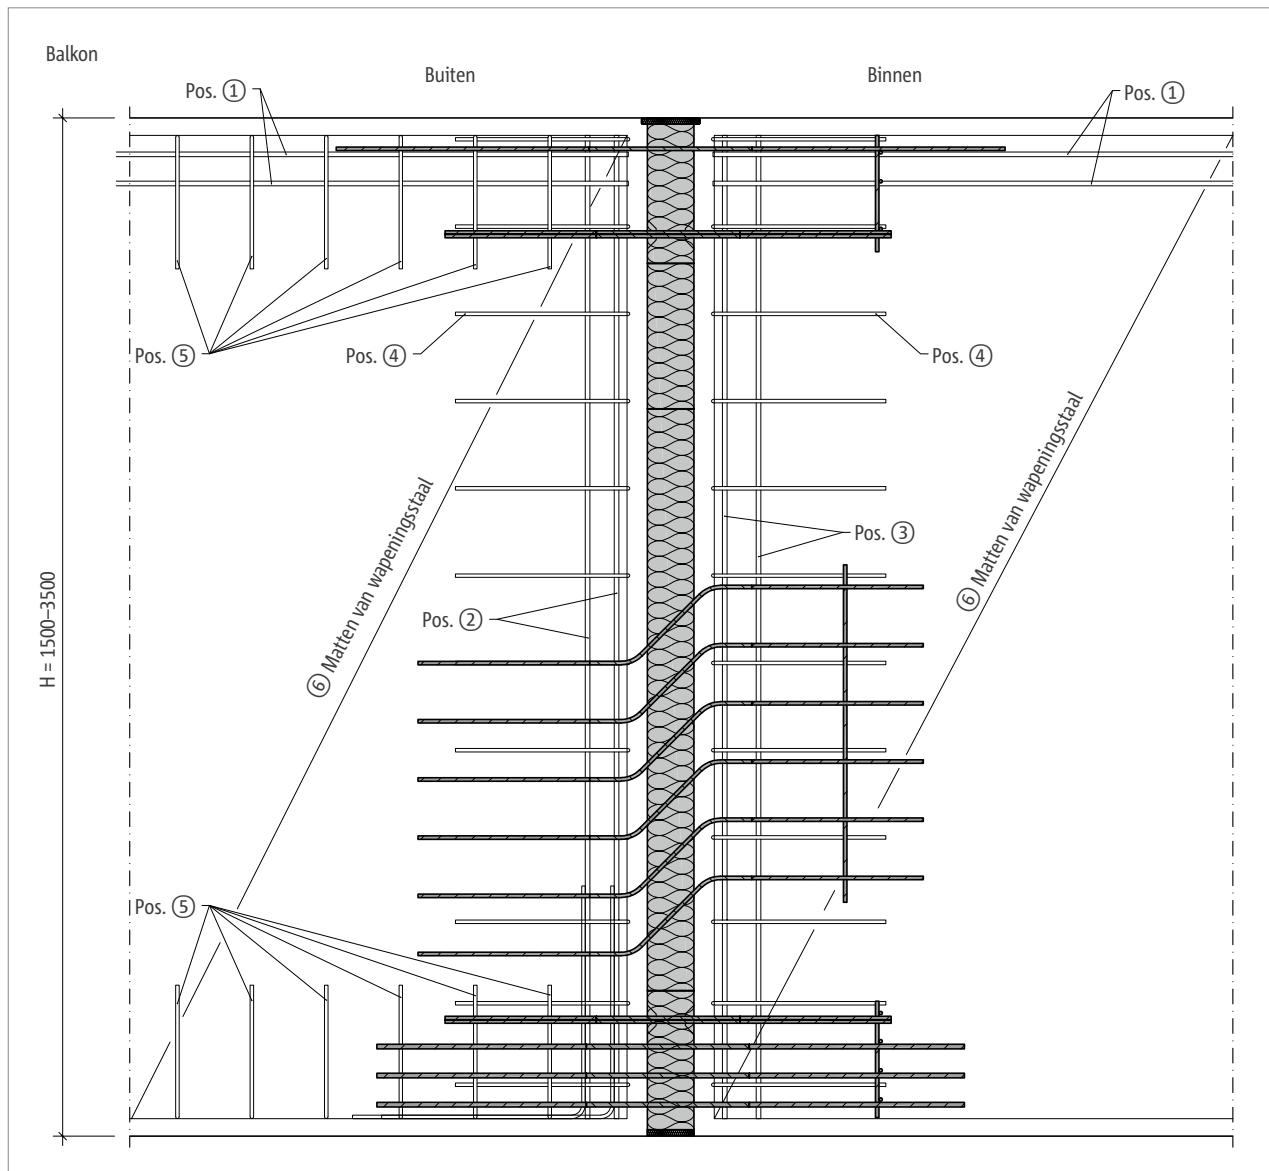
Schöck Isokorf® T type W bij R0: Buitenaanzicht
